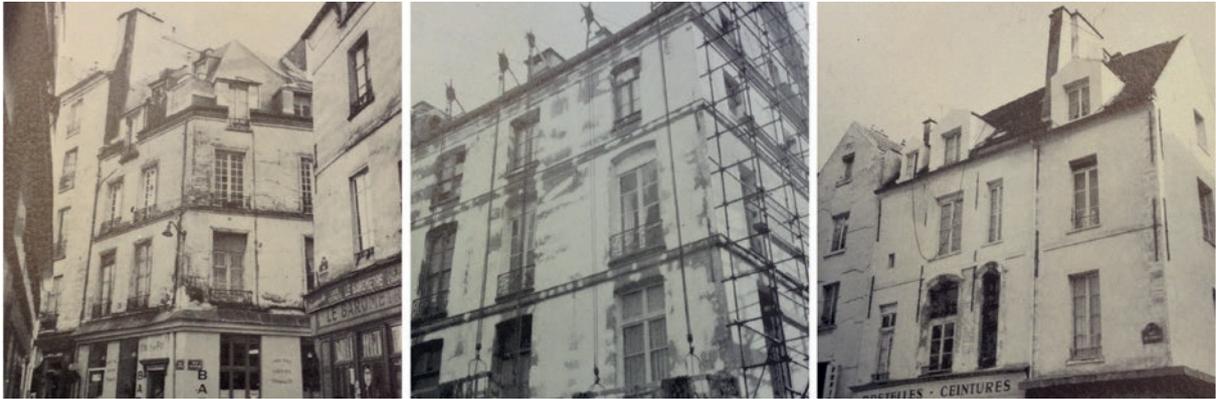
Des chantiers de ravalement au plâtre dans le Marais en 1968. .Source : Philippe Siguret, « Le plâtre au service de la restauration », *Gypsum*, 1968, n° 68.
